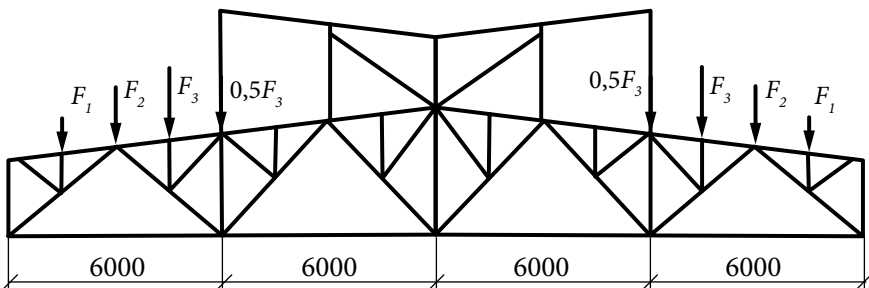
Варианты узловой снеговой нагрузки на ферму
